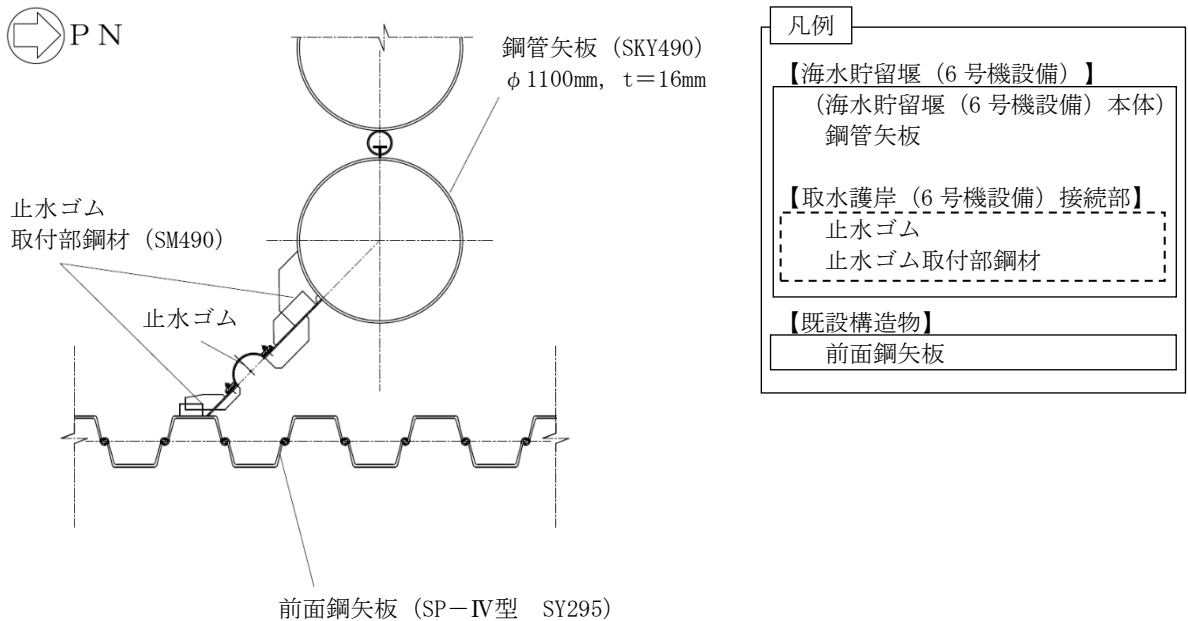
(2) 取水護岸（6号機設備）の平面図（A部拡大）
